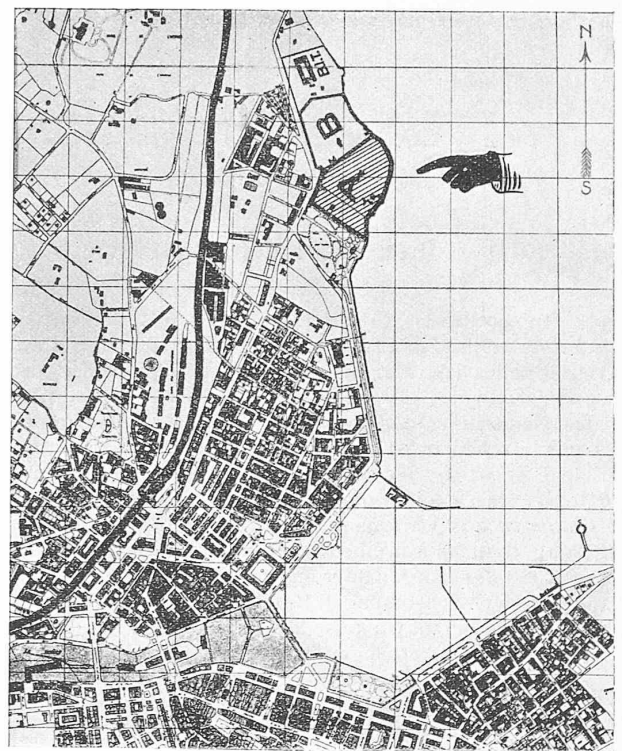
Lageplan des Baugeländes A — Masstab 1 : 25 000.
